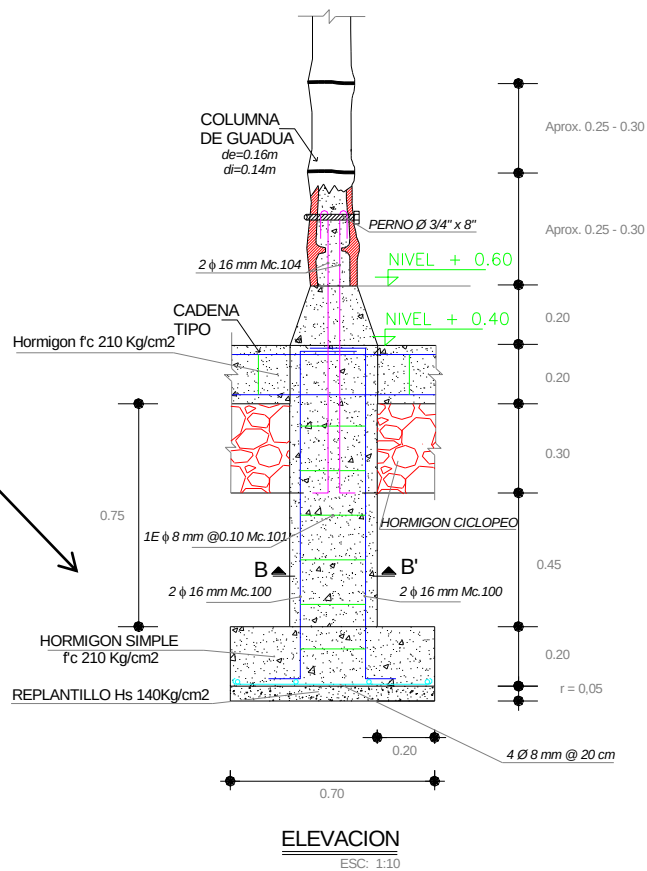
Módulo con plintos de hormigón y columnetas de Guadua.
